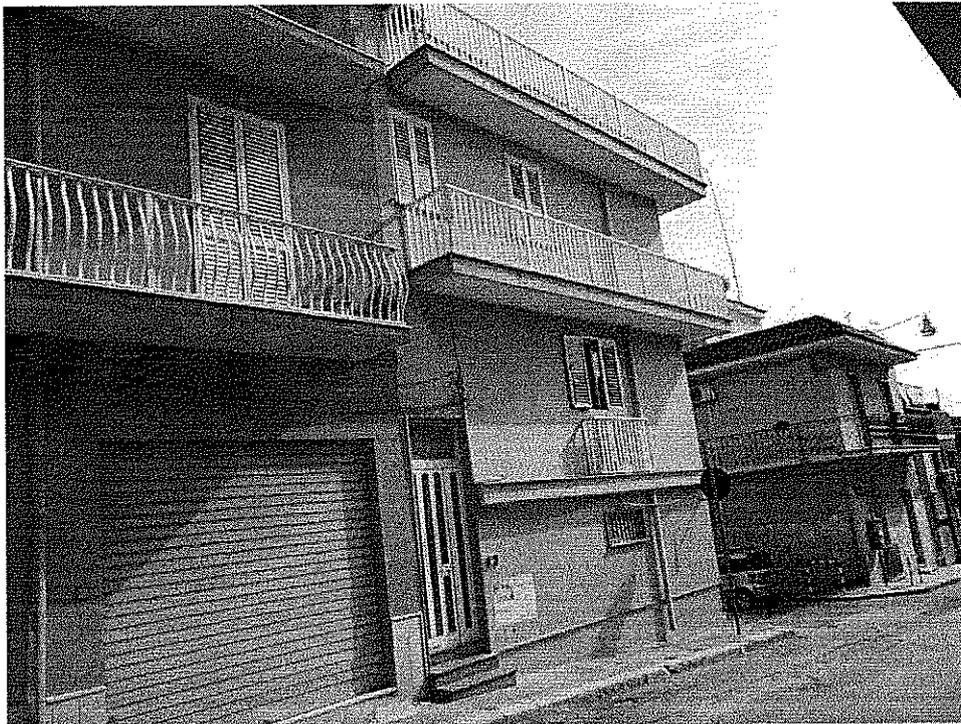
Fabbricato “1A” - Prospetto principale su via Cassar Scalia
